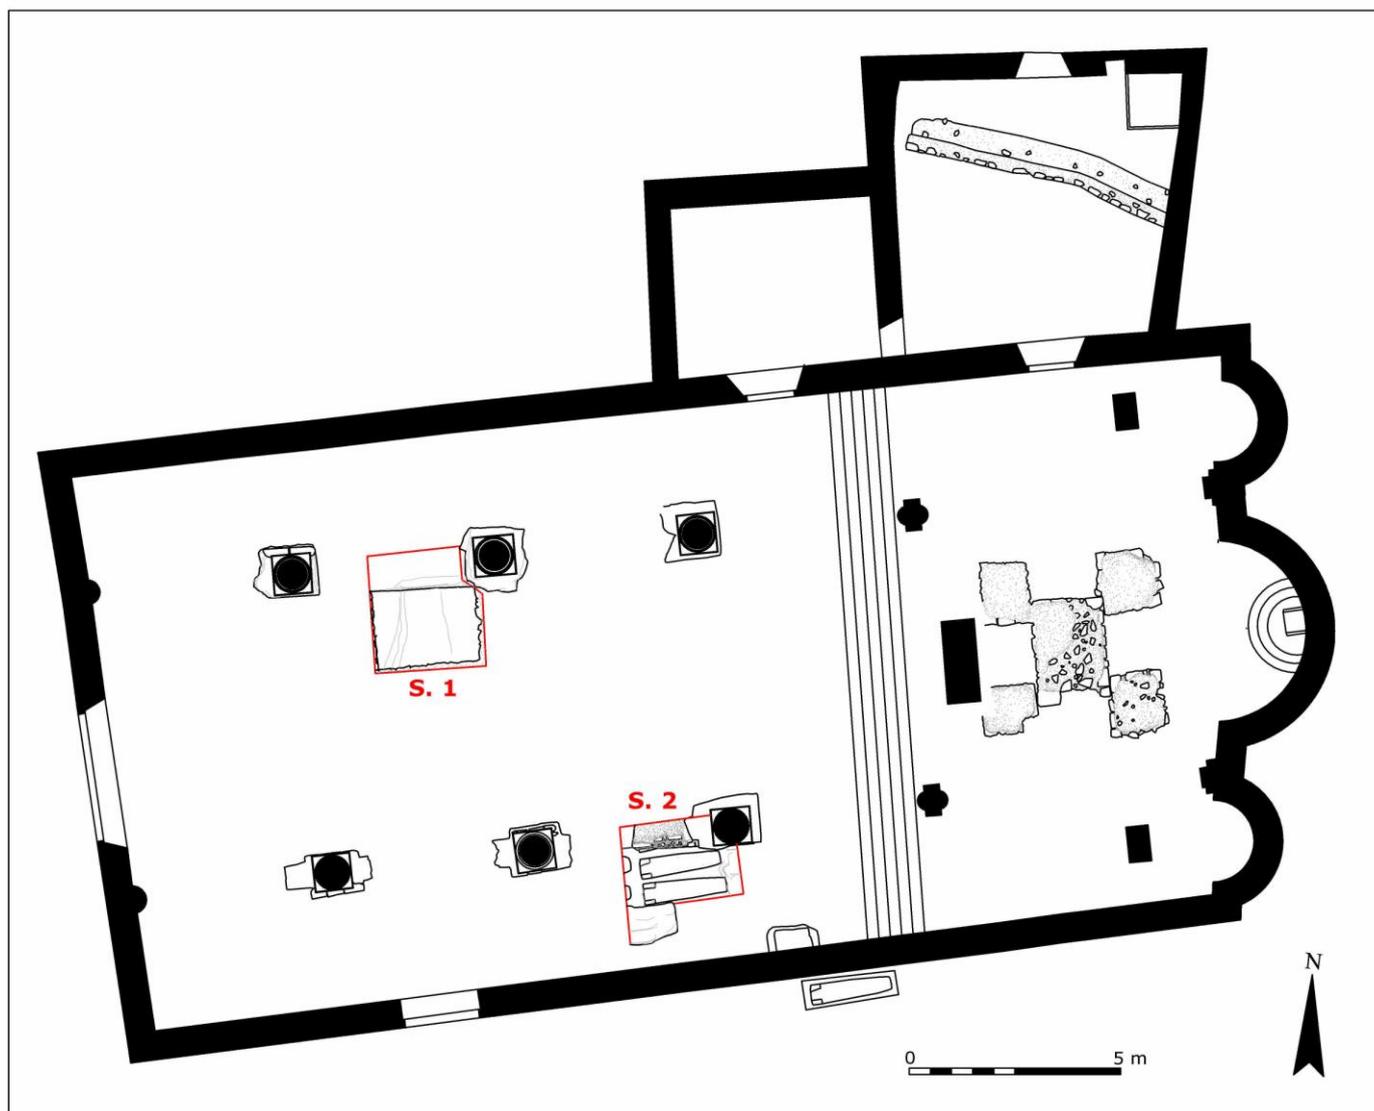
Planimetria generale della chiesa con la localizzazione dei sondaggi e le strutture messe in luce dall'intervento.
